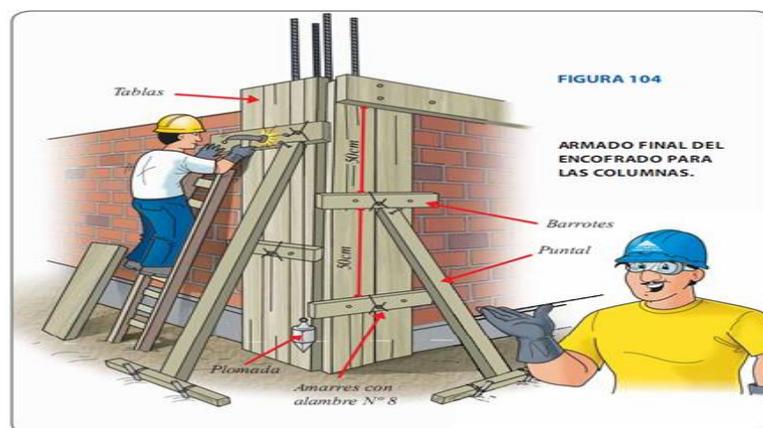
Columnas de albañilería confinada. (Rojas R.)
